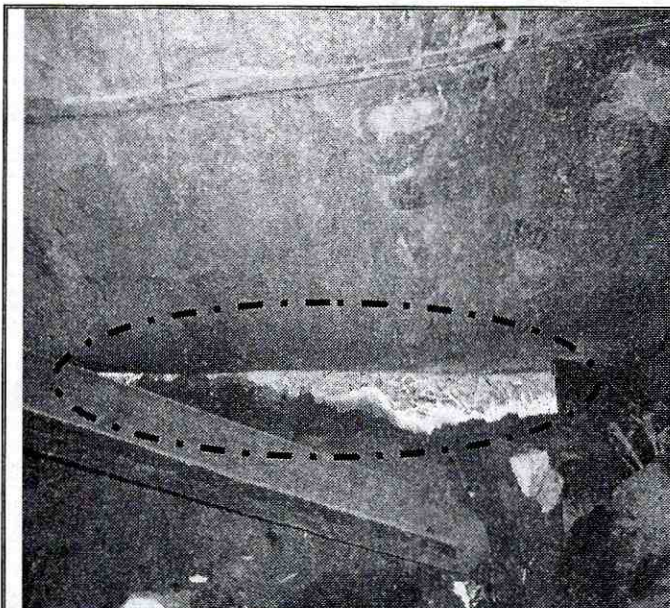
Se observa el colapso del muro de cerramiento y el impacto hacia la vivienda de la Calle 78 C Sur No. 14-26.
